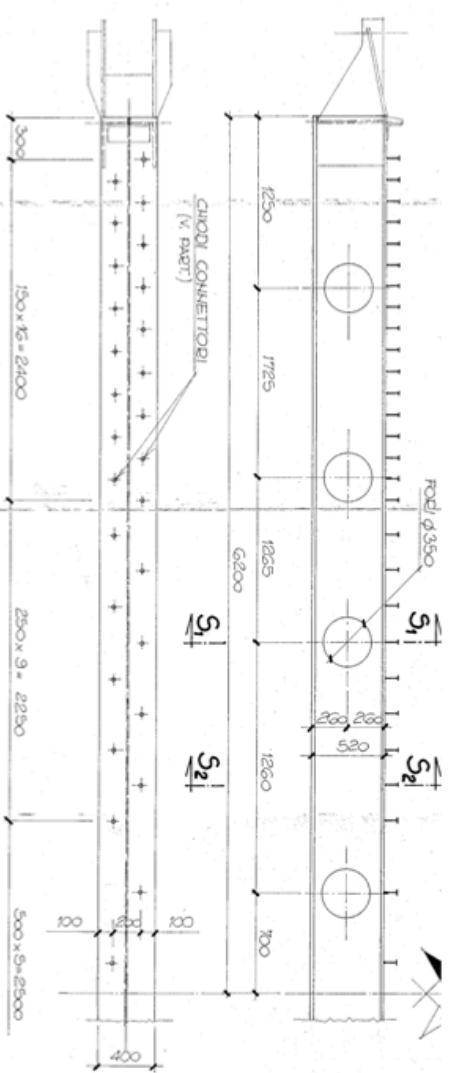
Vista in pianta e prospettiva della trave metallica
